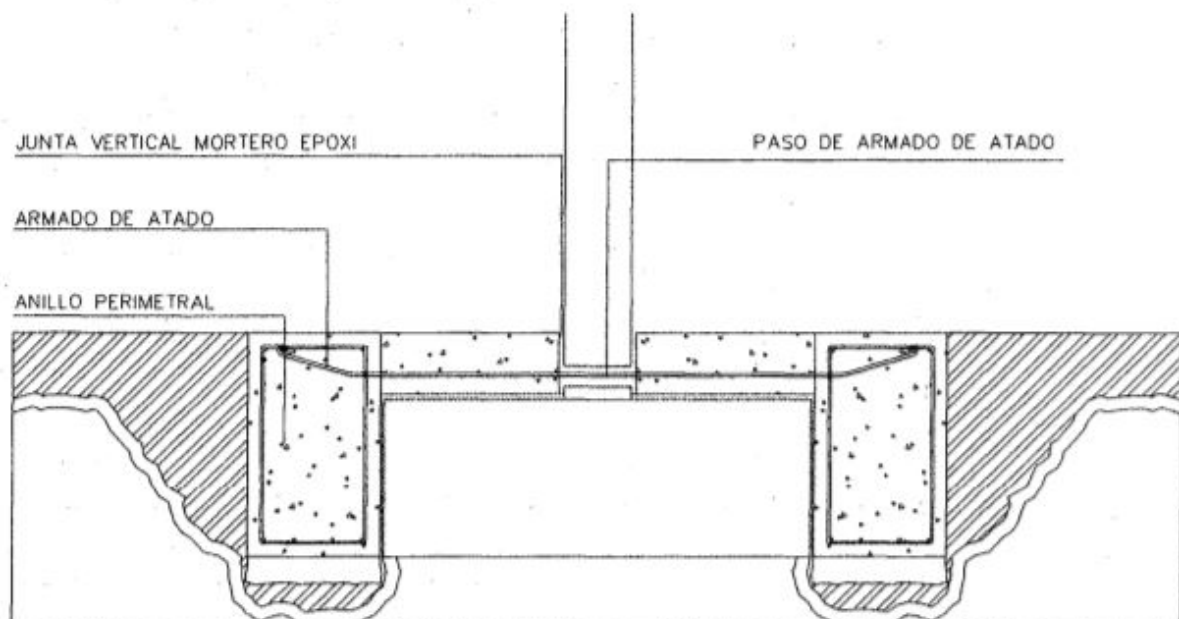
Recalce superficial de zapata aislada aumentando su superficie de apoyo mediante un anillo perimetral de hormigón armado unido por armaduras de atado superiores.
